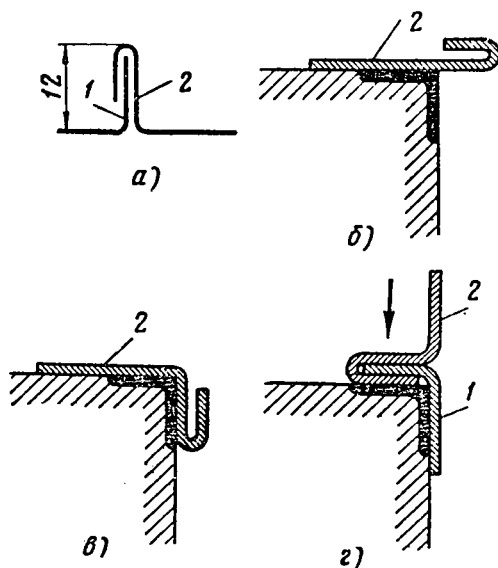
Изготовление одинарного стоячего фальца ручным способом:
